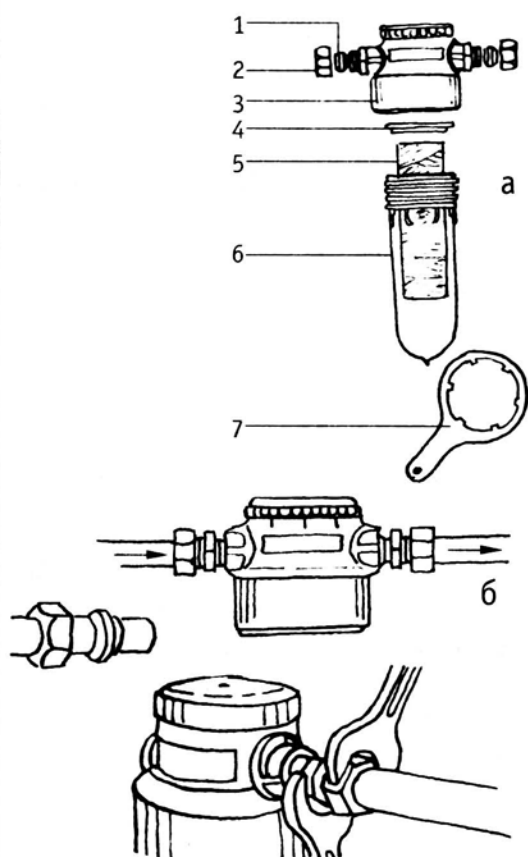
Фильтр «Instapure»; модель 1F-20A механической очистки воды для всей квартиры: а — деталировка; б — монтаж; 1 — прокладка; 2 — накидная гайка; 3 — крышка; 4 — прокладка крупная; 5 — фильтр; 6 — корпус; 7 — ключ
